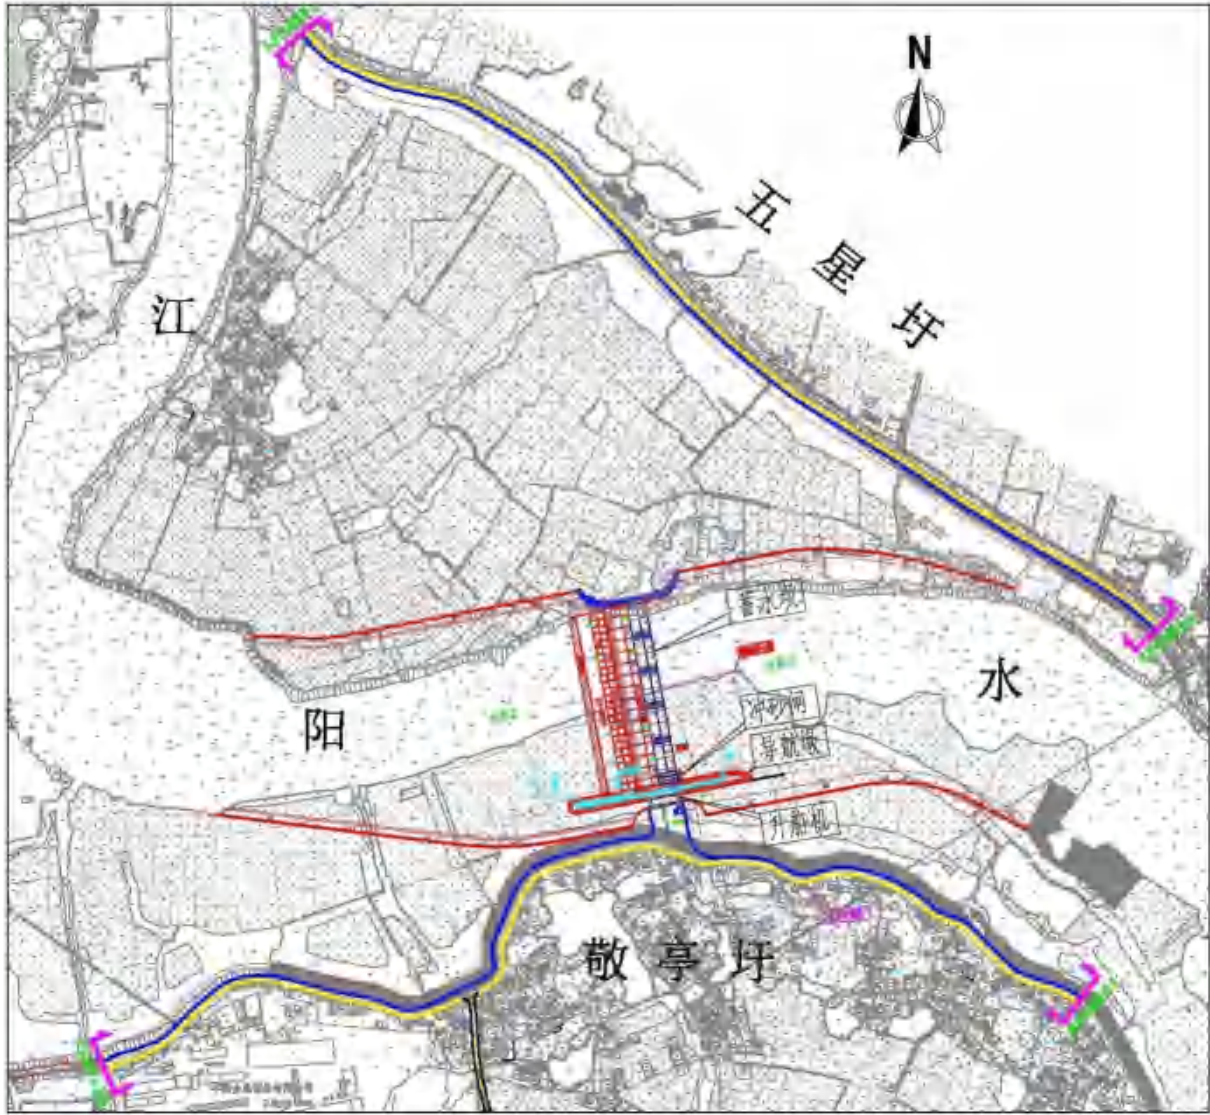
海棠湾枢纽工程上下游河道平面图
